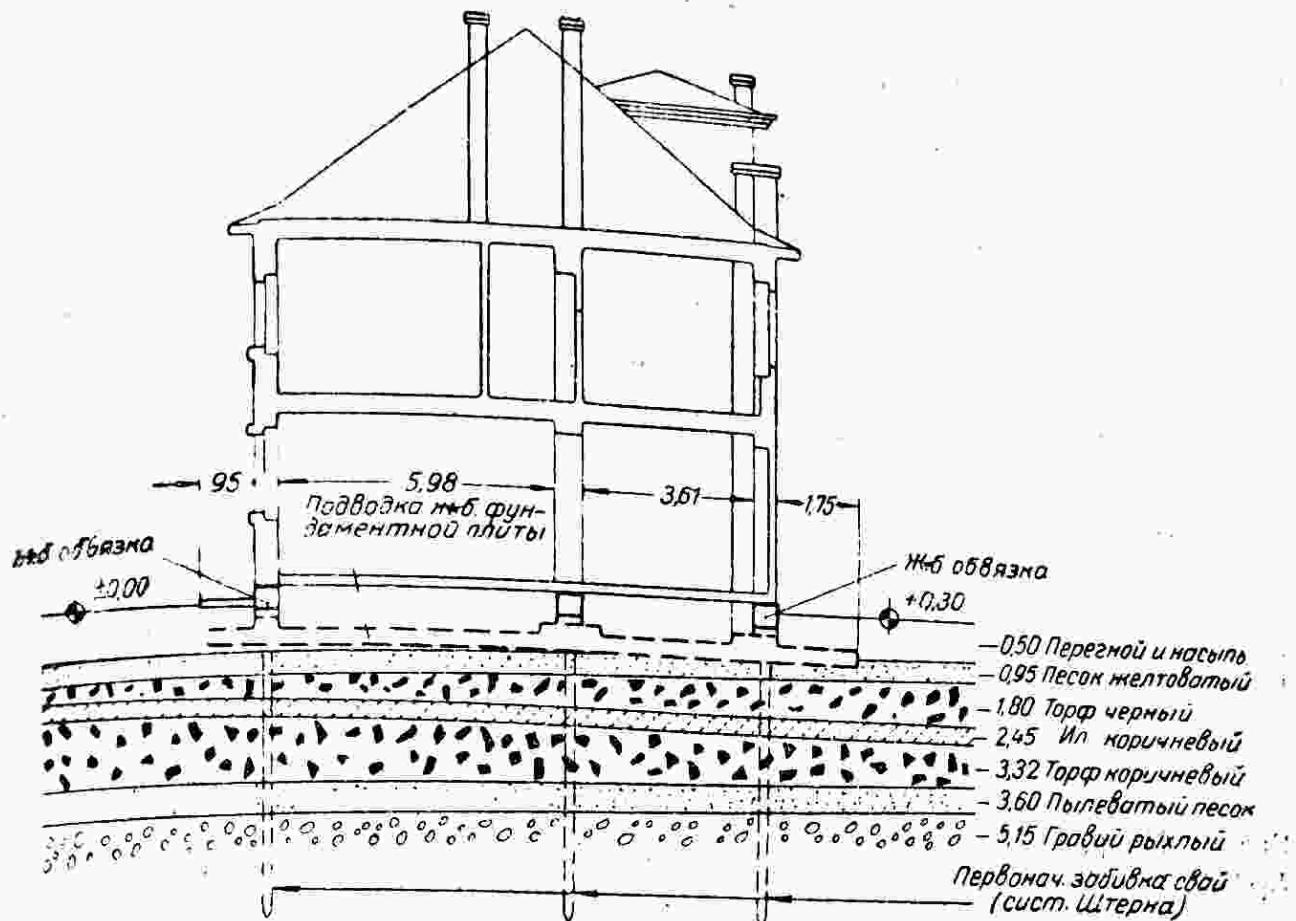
Фундаменты рабочего павильона больницы в Андьялфельде
